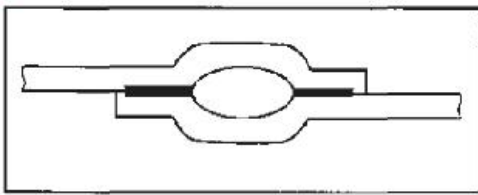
K316013-2 双缝热熔焊接焊缝示意图
